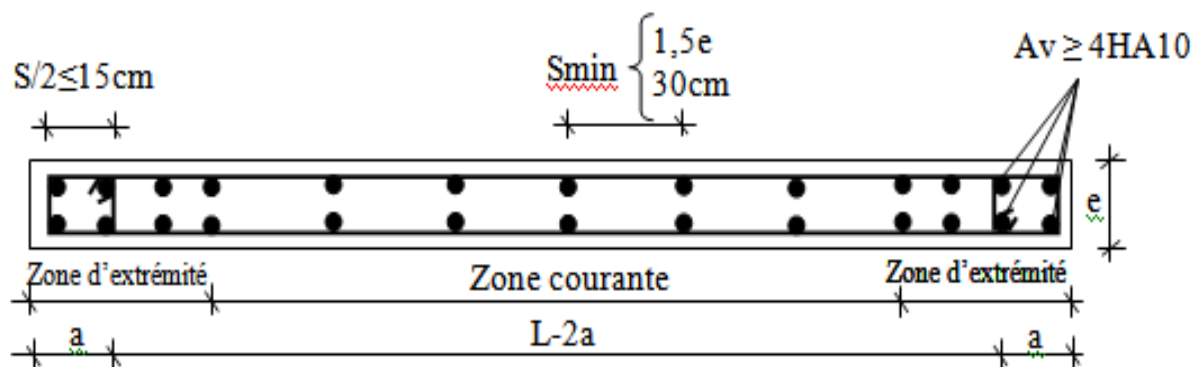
Disposition des armatures verticales dans les voiles
